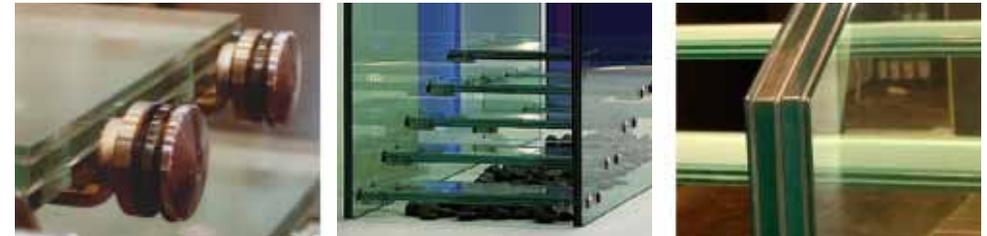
Details eine Nurglastreppenanlage nach dem Stahlglasprinzip (quelle: www.stahlglas.net)
